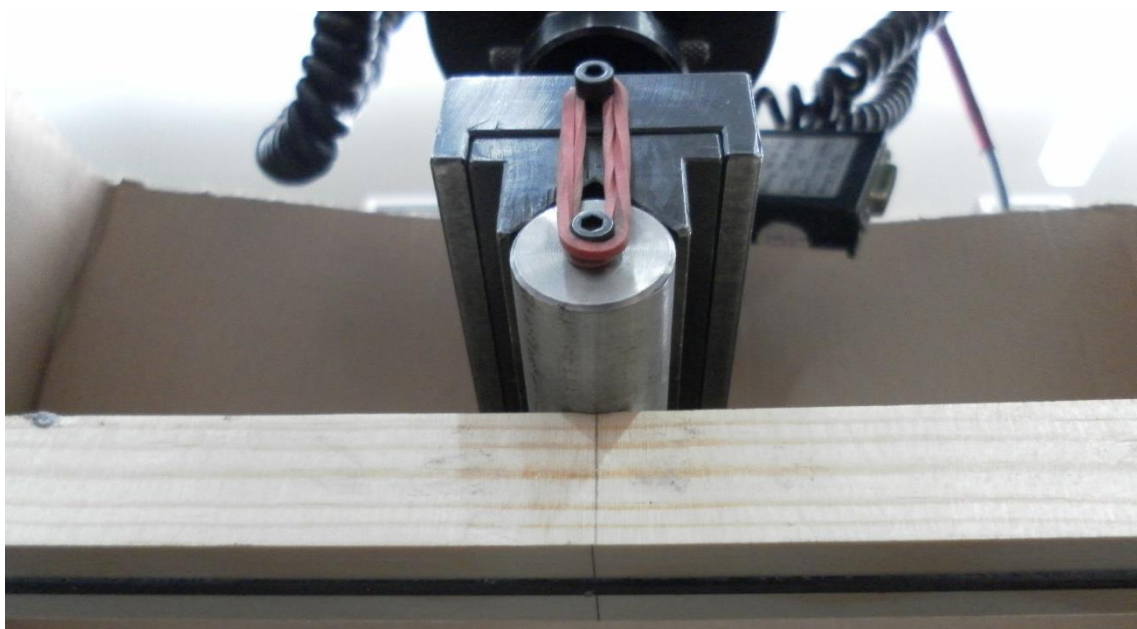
Contacto do rolete cilíndrico da célula de carga com o provete.
